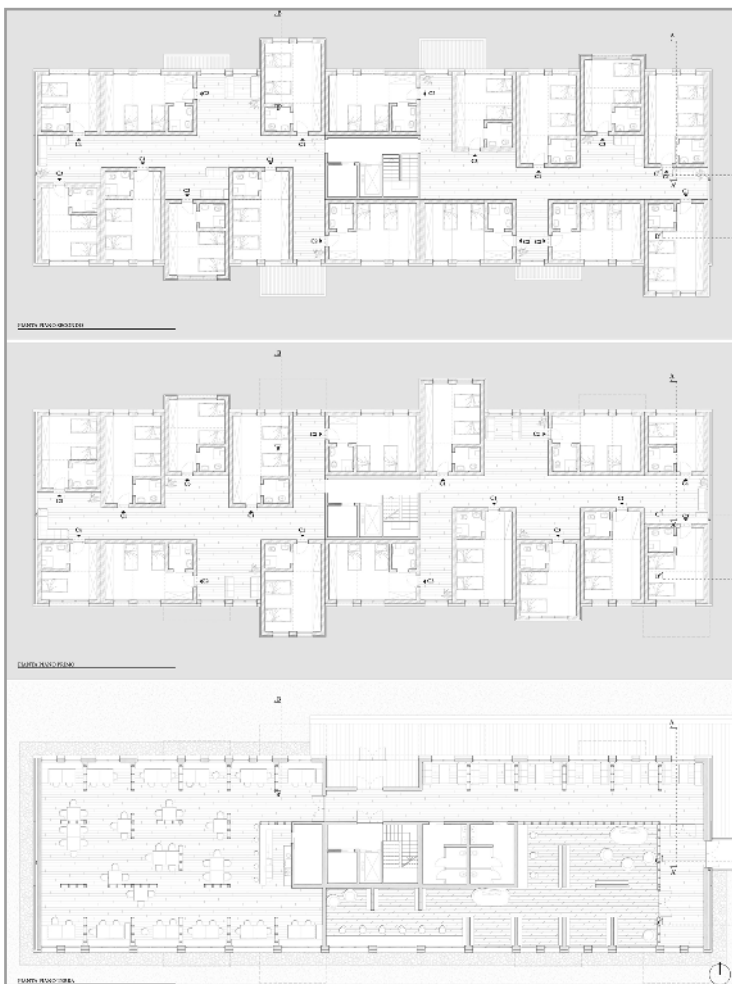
piante piano terra, piano primo e piano secondo di un edificio tipo
